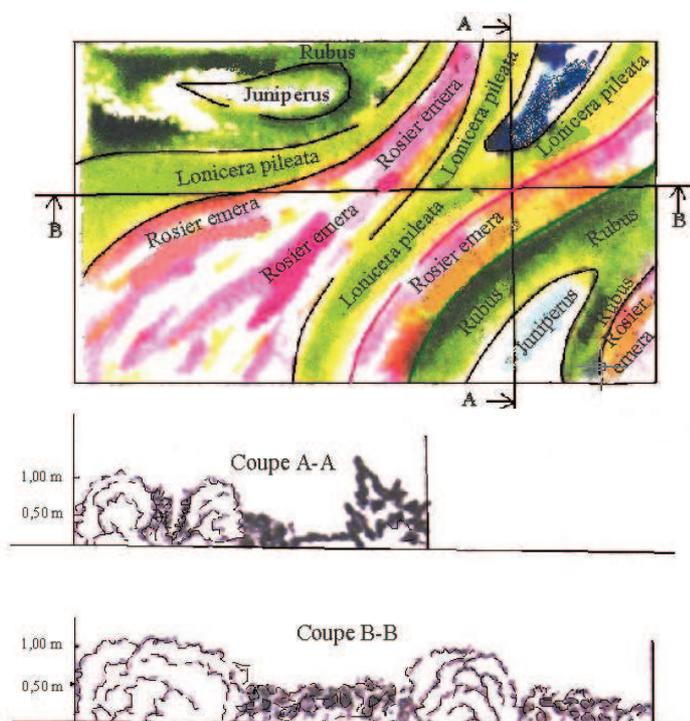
Exemple de plan de plantation d'une toiture végétalisée semi- intensive.
